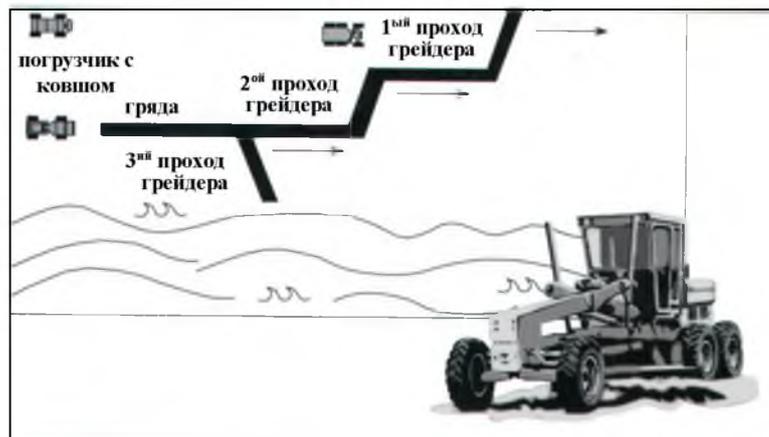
Двух ступенчатый сбор с помощью грейдера и погрузчика и/или скрепера
